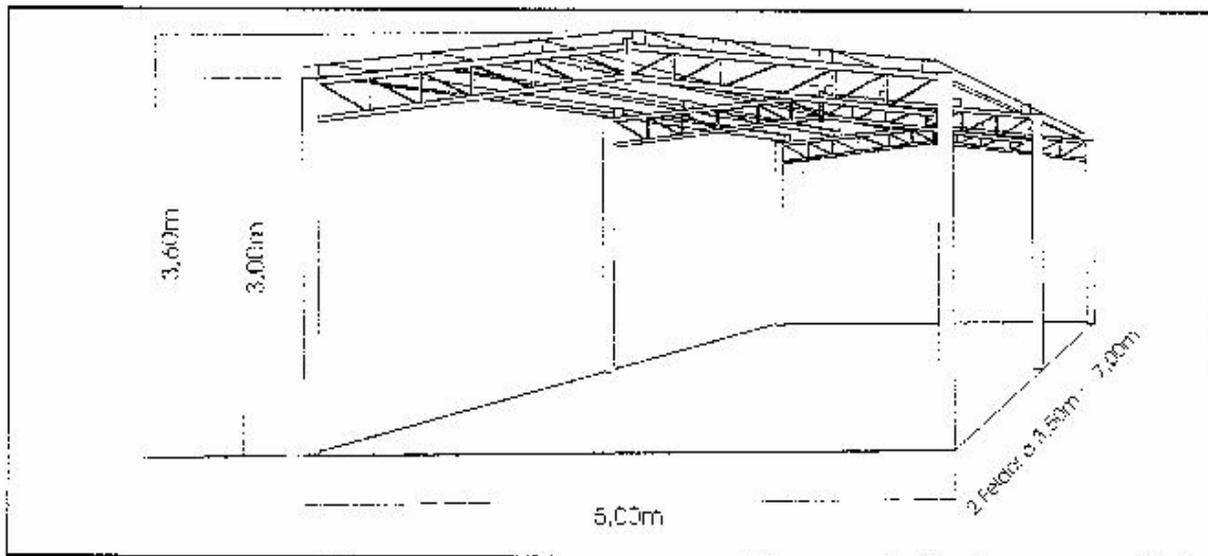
Mehrzweckhalle Typ SD 5 - 5,00 m Spannweite, Dachneigung 13°
